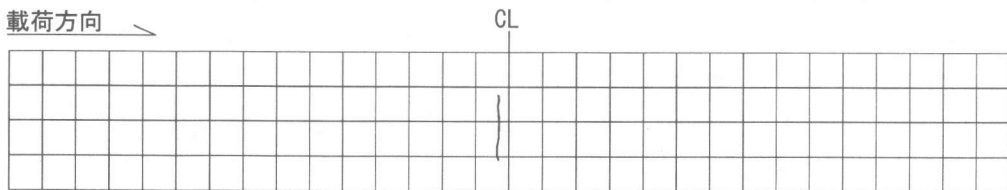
コンクリート床版上縁ひび割れ観察図
